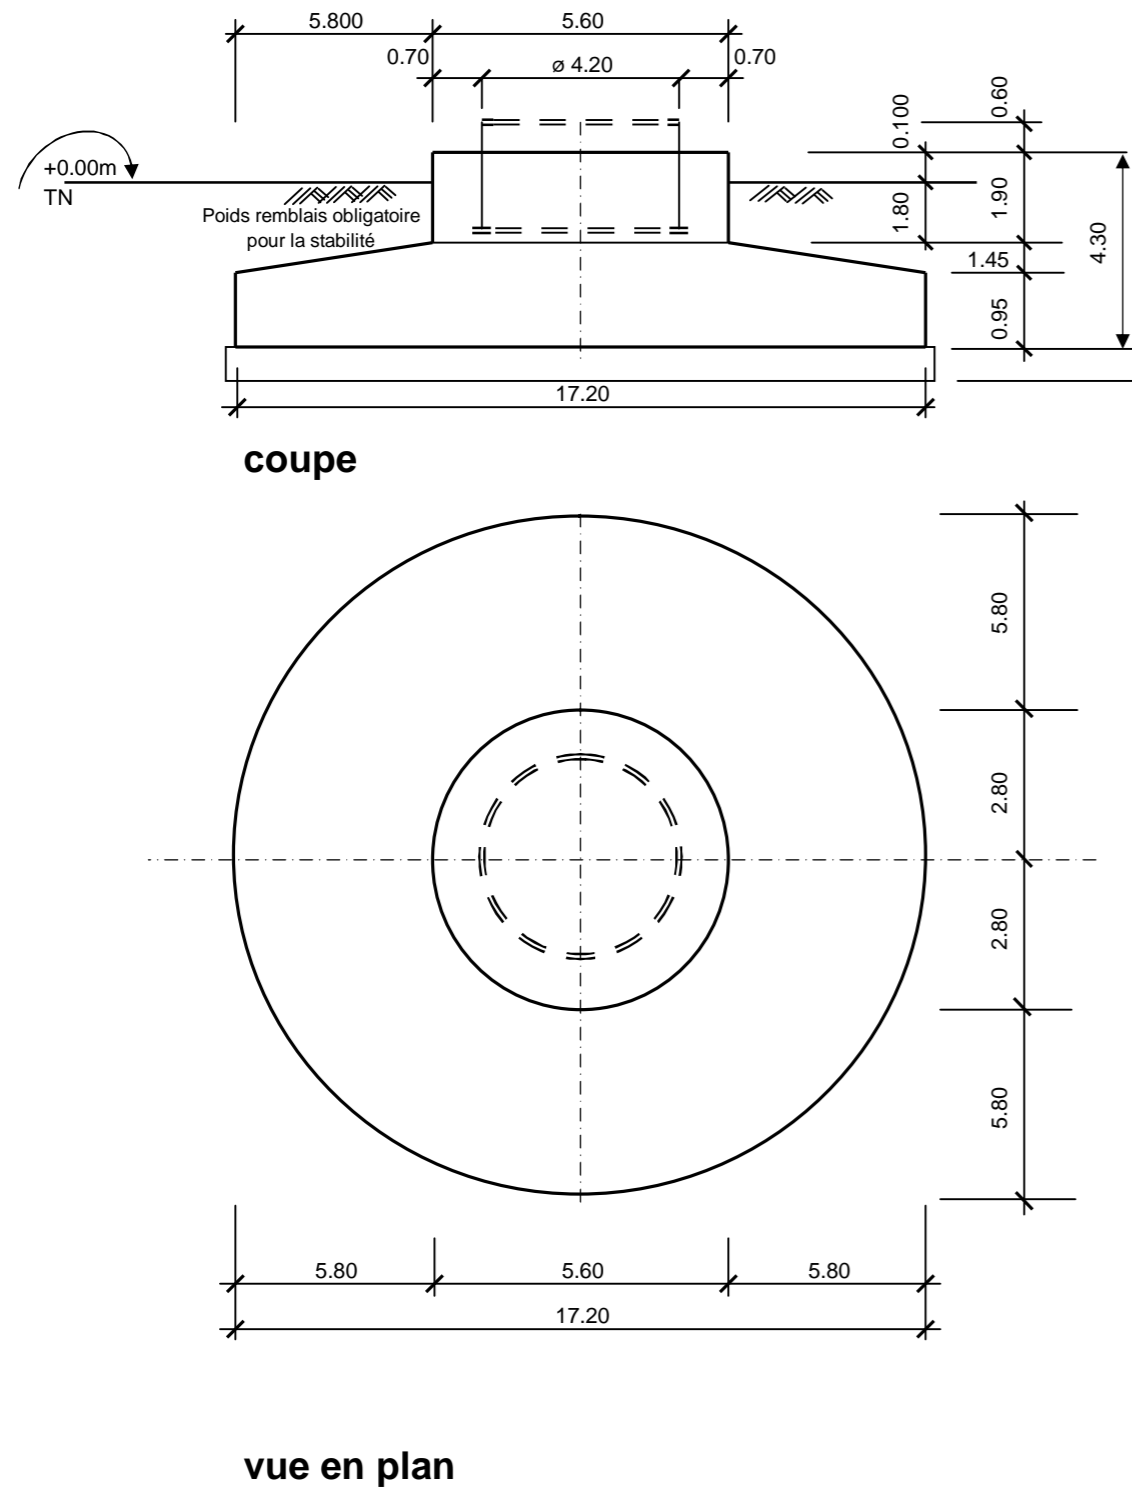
Exemple de plan de fondation d'une éolienne Vestas V90 3.0 MW
